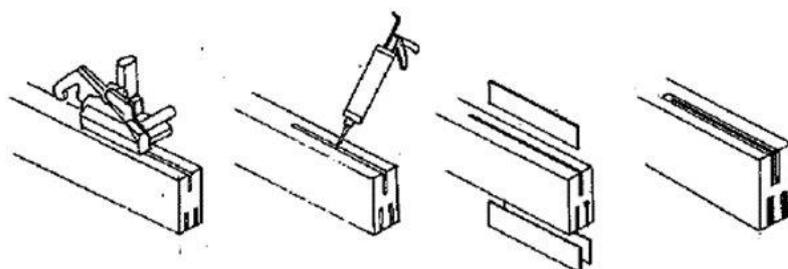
Procedimentos do reforço de vigas através da aplicação de placas de reforço internas, seladas com cola epoxídica (Pinto, 2008)
